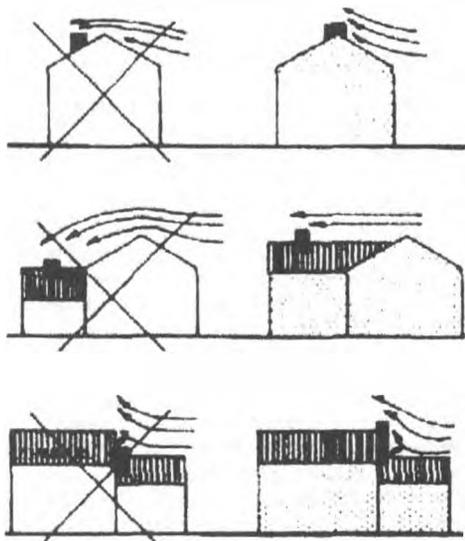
Схемы установки вентиляционных труб на крыше
